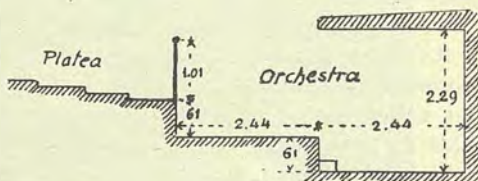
Disposizione dell'orchestra nel teatro di New-Orleans, secondo Harrod.
